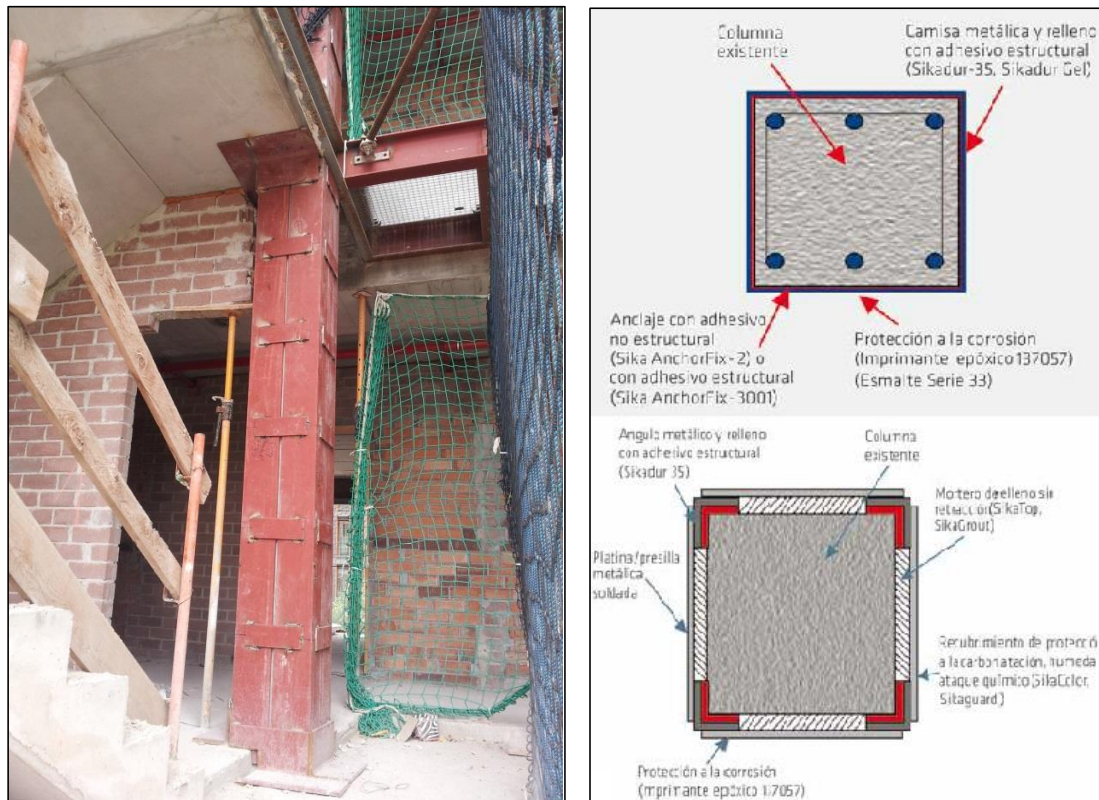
Enchaquetado por empresillado metálico. Fuente: SIKA, 2017
